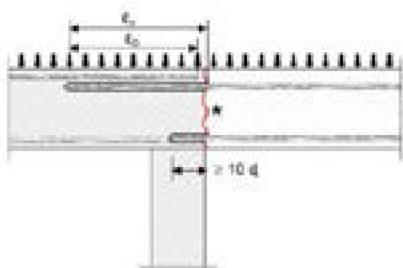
Transpasse em fundação de um pilar onde os vergalhões são exigidos na tração.
